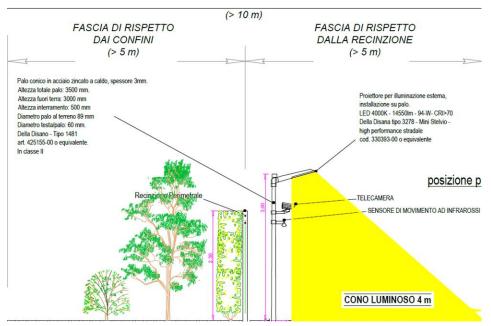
Sezione tipo della fascia perimetrale di mitigazione
